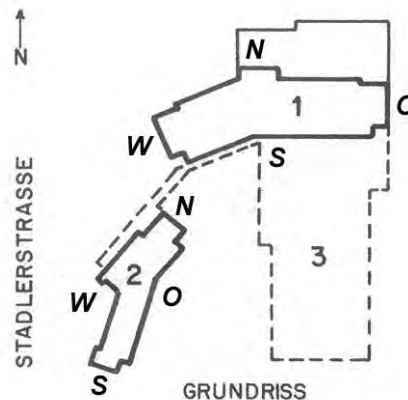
Grundriss Alterszentrum Oberi
